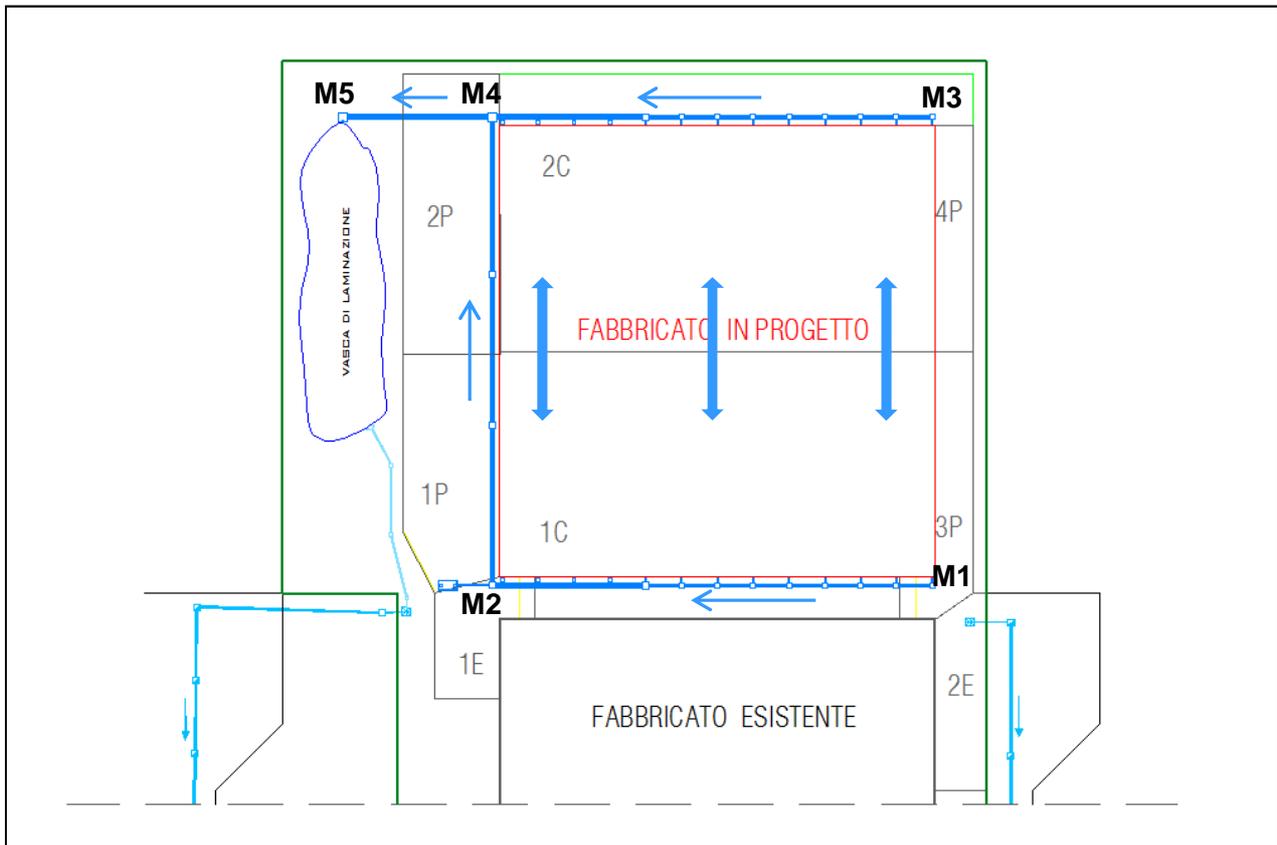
Planimetria rete meteorica di copertura (blu).
